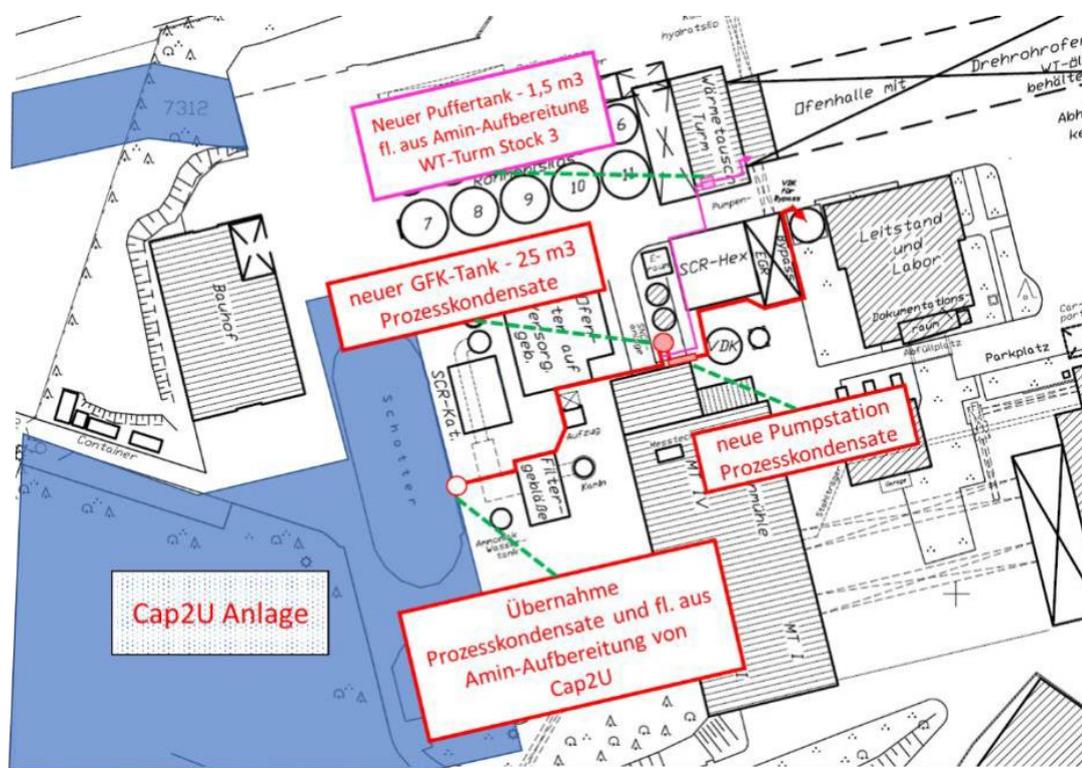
Lageplan mit geplanter Tank- und Pumpstation Prozesskondensat sowie geplanter Tank für Flüssigkeiten aus der Amin-Aufbereitung
